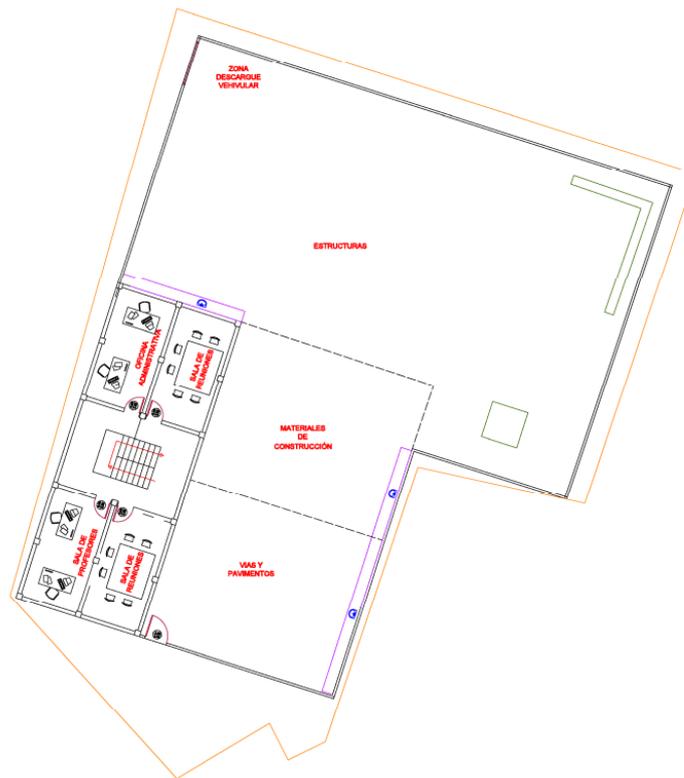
Diseño arquitectónico - Planta alta [autoría propia]
